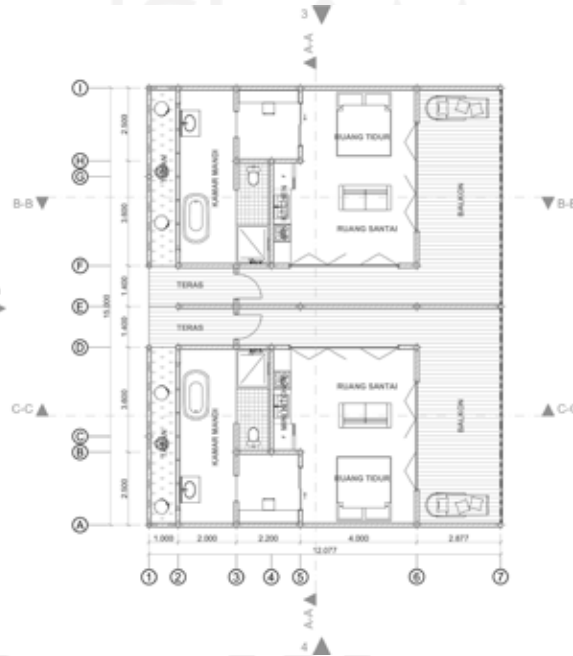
Denah Bangunan Unit tipe Deluxe
